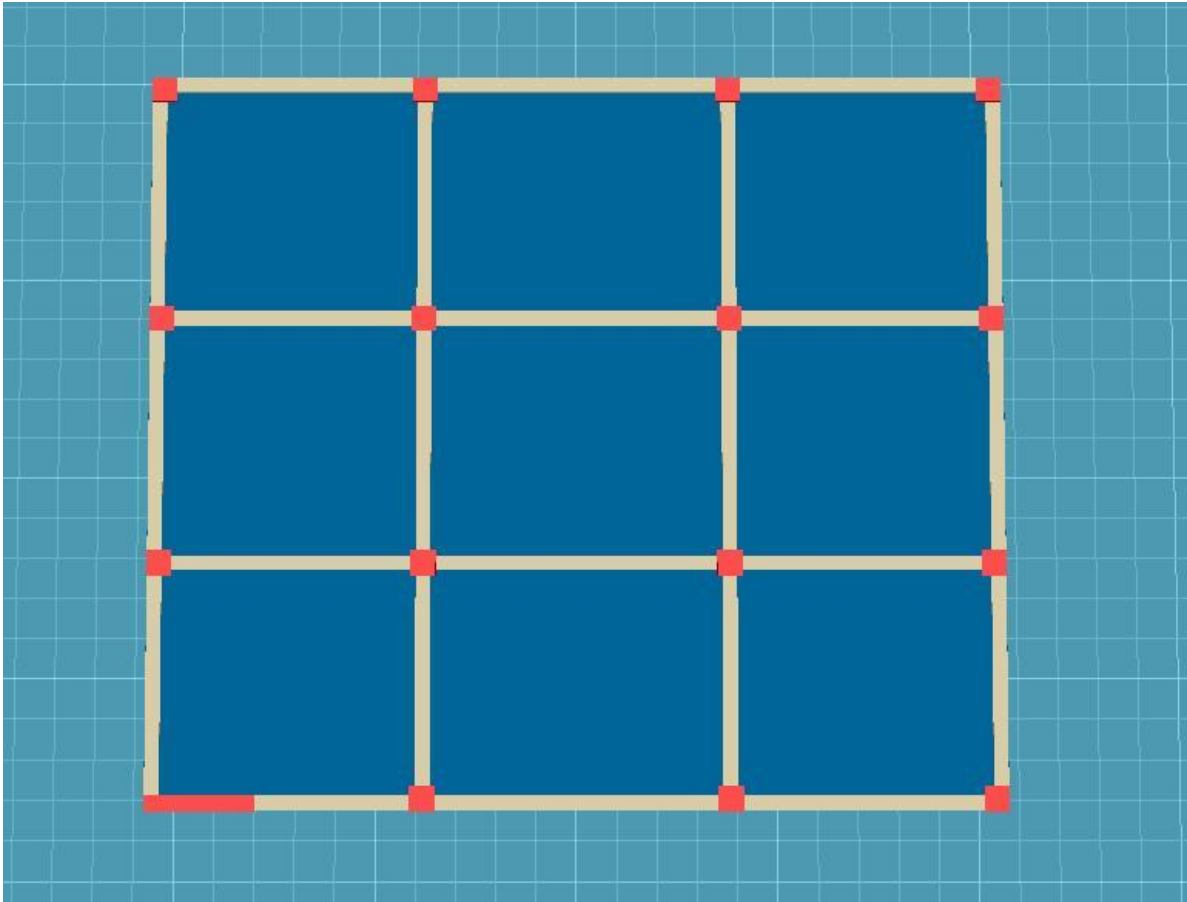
İncelenen 2. A Tipi Yapı Planı
